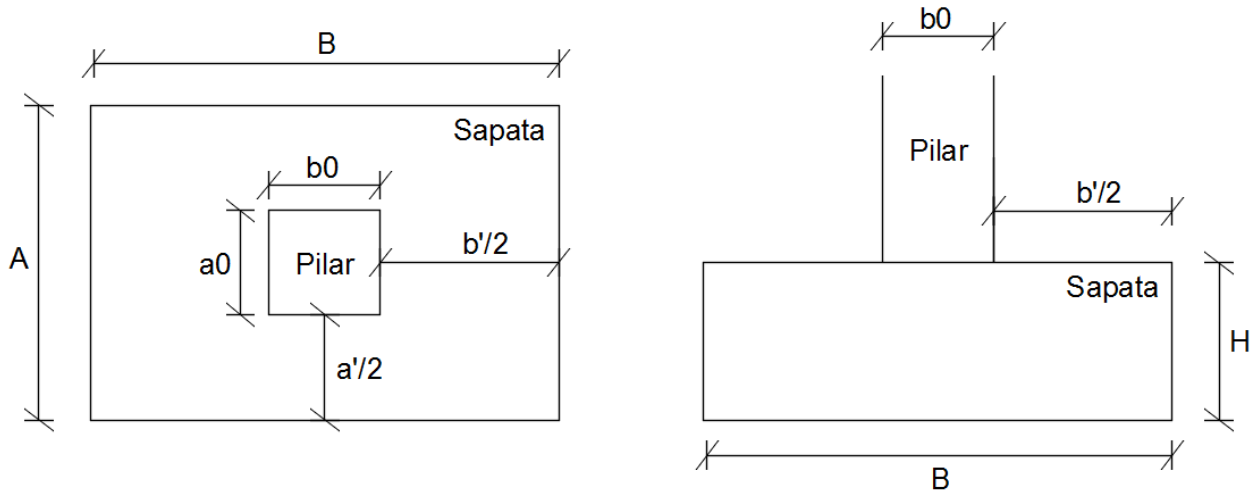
Vista em planta e alçado de uma sapata tipo
